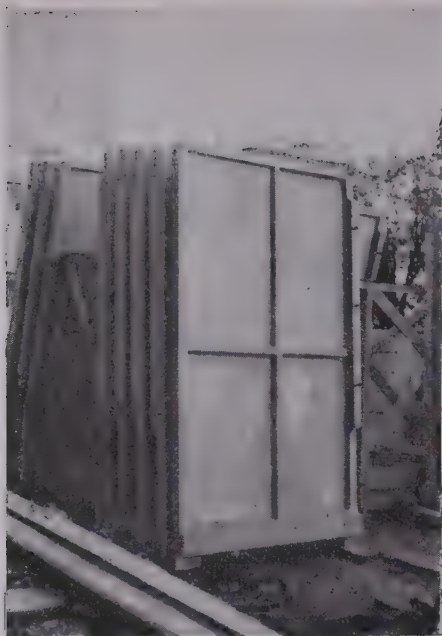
Vue de la face intérieure d'une plaque de façade.
